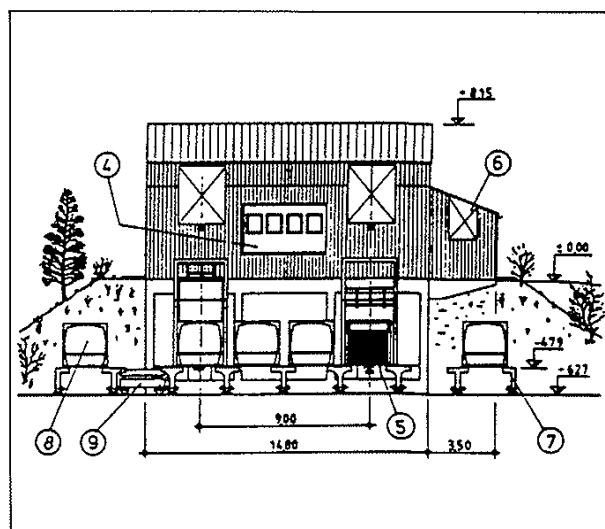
Stazione Fissa di Trasferimento – Prospetti e sezioni
